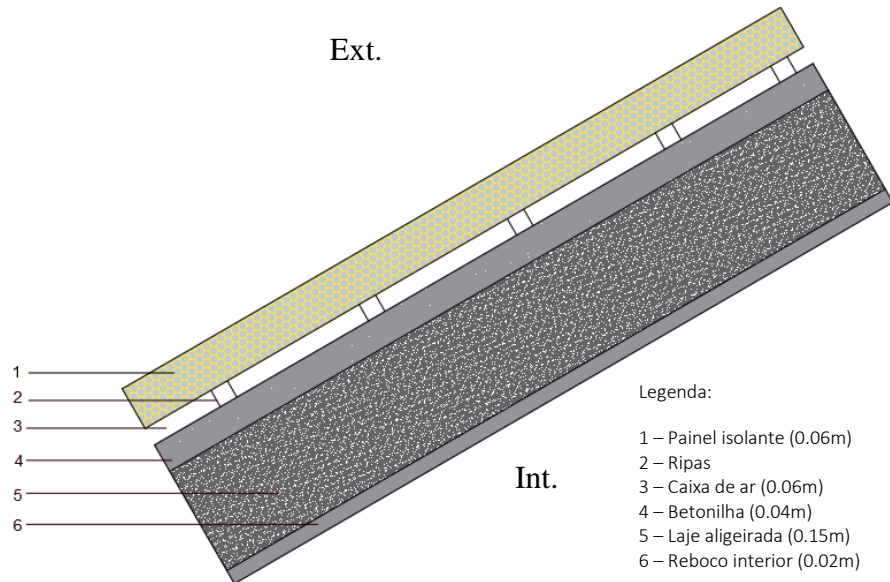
Pormenor construtivo referente à solução construtiva painel “sandwich”
